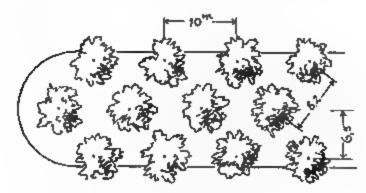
Grundriß bei dreifacher Reihenbildung mit versetzter Baumstellung
